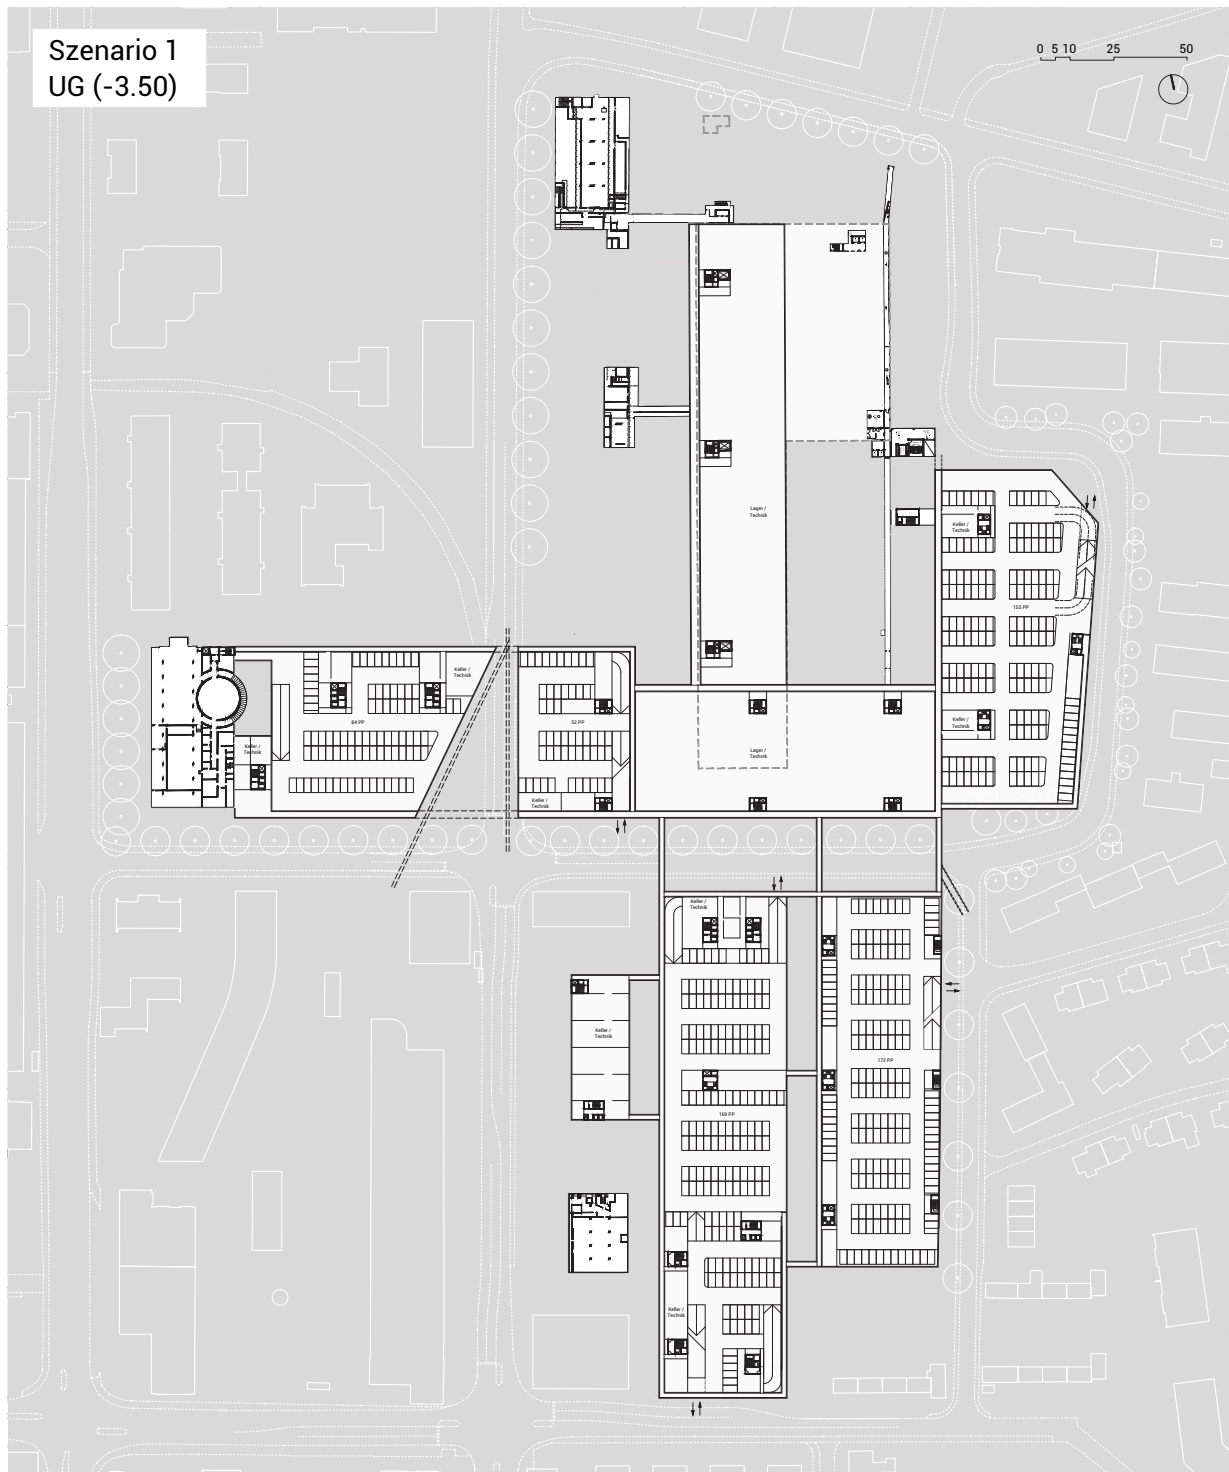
Grundriss UG Szenario 1
